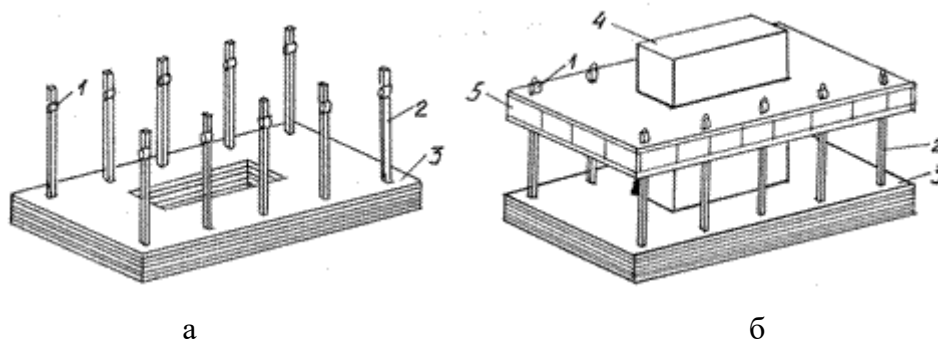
Схема монтажу будівель методом підйому поверхів; а – встановлені колони, вкладені в пакет плити всіх перекриттів; на оголовки колон встановлені гідравлічні домкрати; б – зведені шахта, дах та верхній поверх піднято на проєктну позначку; 1 – гідропідйомники; 2 – колони; 3 – плити перекриттів; 4 – сходово-ліфтова шахта; 5 – змонтований і піднятий на проєктну позначку верхній поверх
